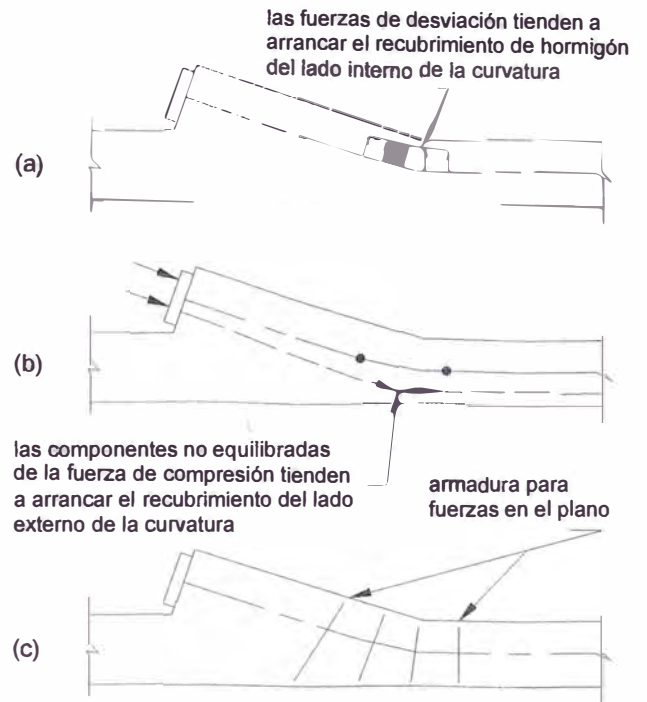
Fuerzas en el plano en un taco para anclaje
